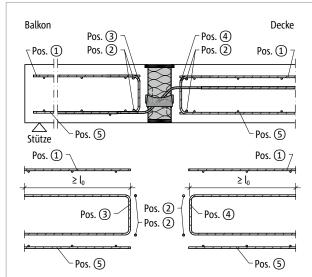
Schöck Isokorb® T Typ QL: Bauseitige Bewehrung
